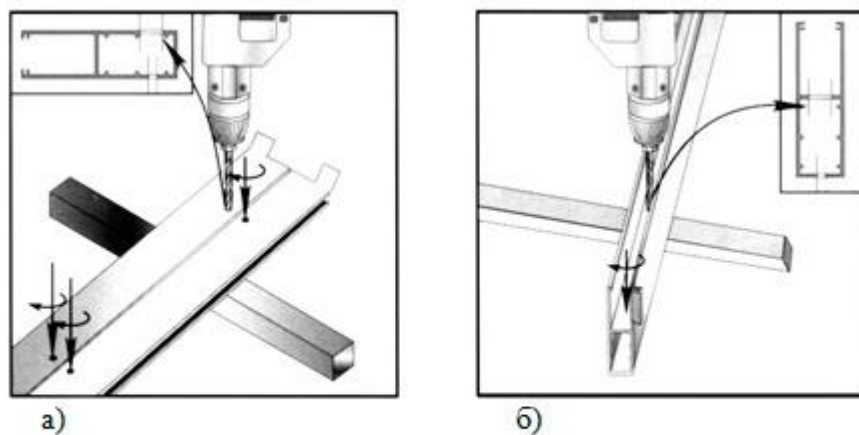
Рассверливание отверстий Ø 11,8 мм в направляющих: а – накладной монтаж; б – встроенный монтаж.
